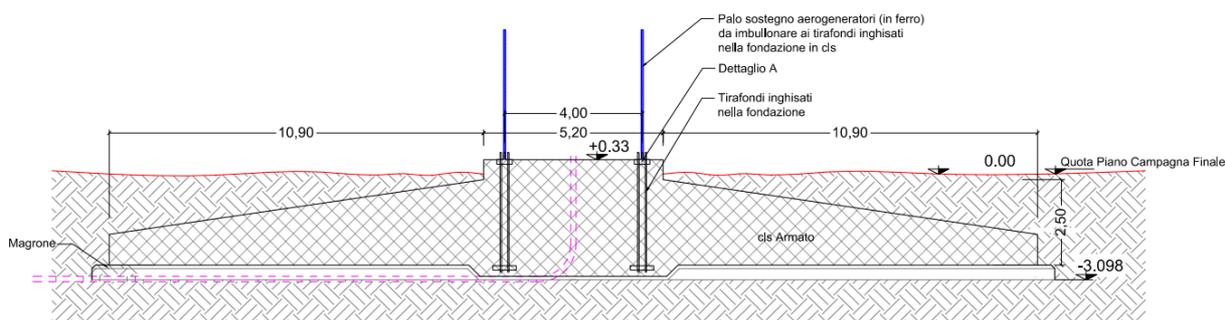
Tipico sezione fondazione Aerogeneratore
